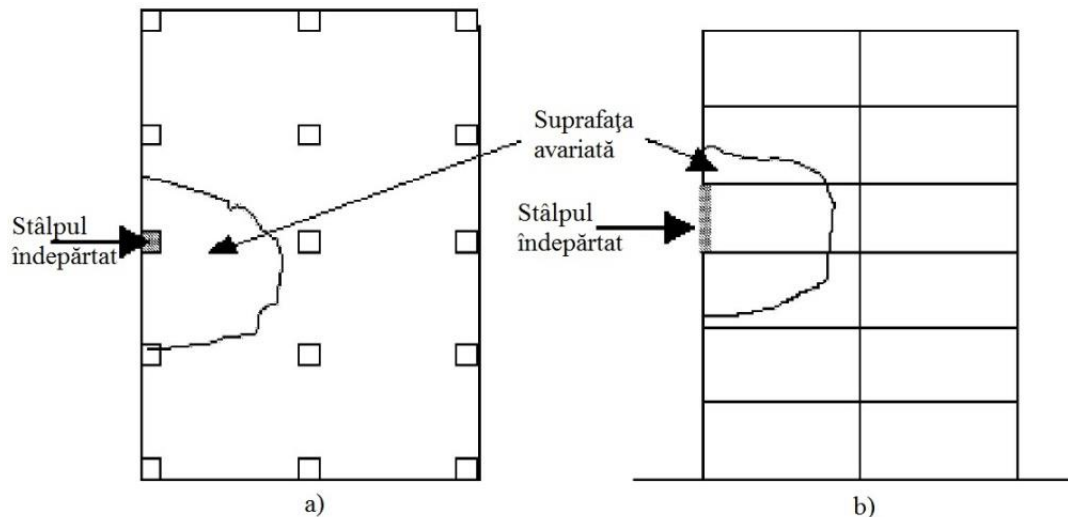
Limita admisă a avariei: a) în plan și b) în elevație [5]
